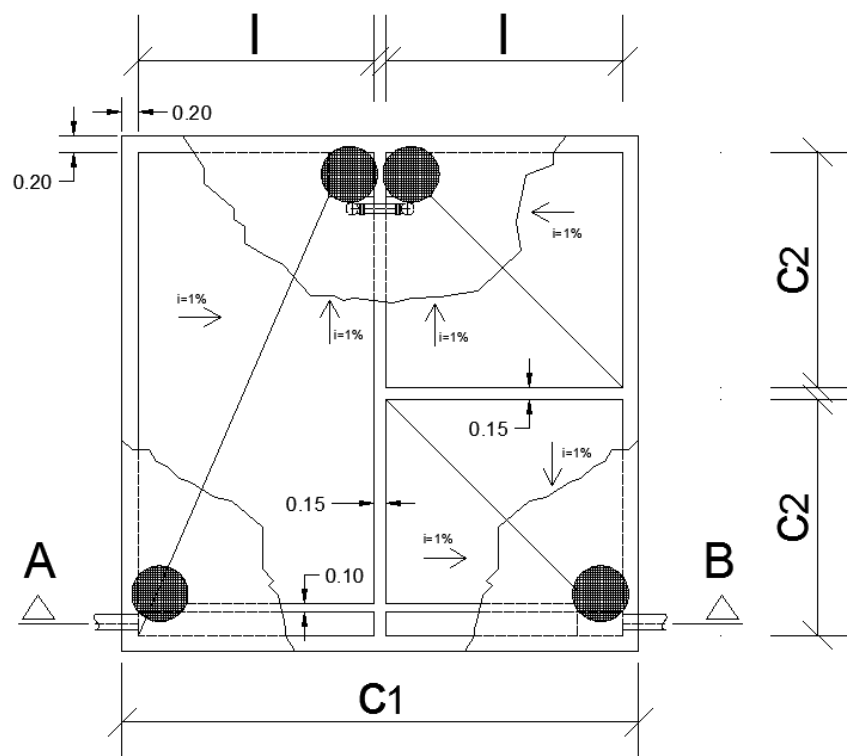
Planta do modelo de fossa séptica proposto para o caso de estudo (dimensões em metros).
